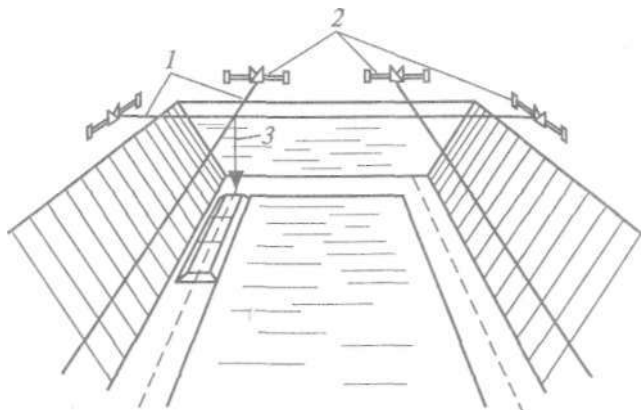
Схема разбивки ленточных сборных фундаментов: 1 — монтажная проволока; 2 — строительные скамейки; 3 — отвес
